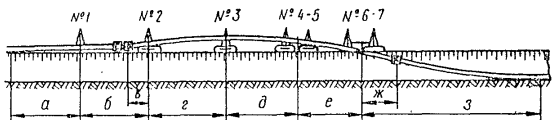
Схема размещения механизмов при совмещенном способе изоляционно-укладочных работ:
